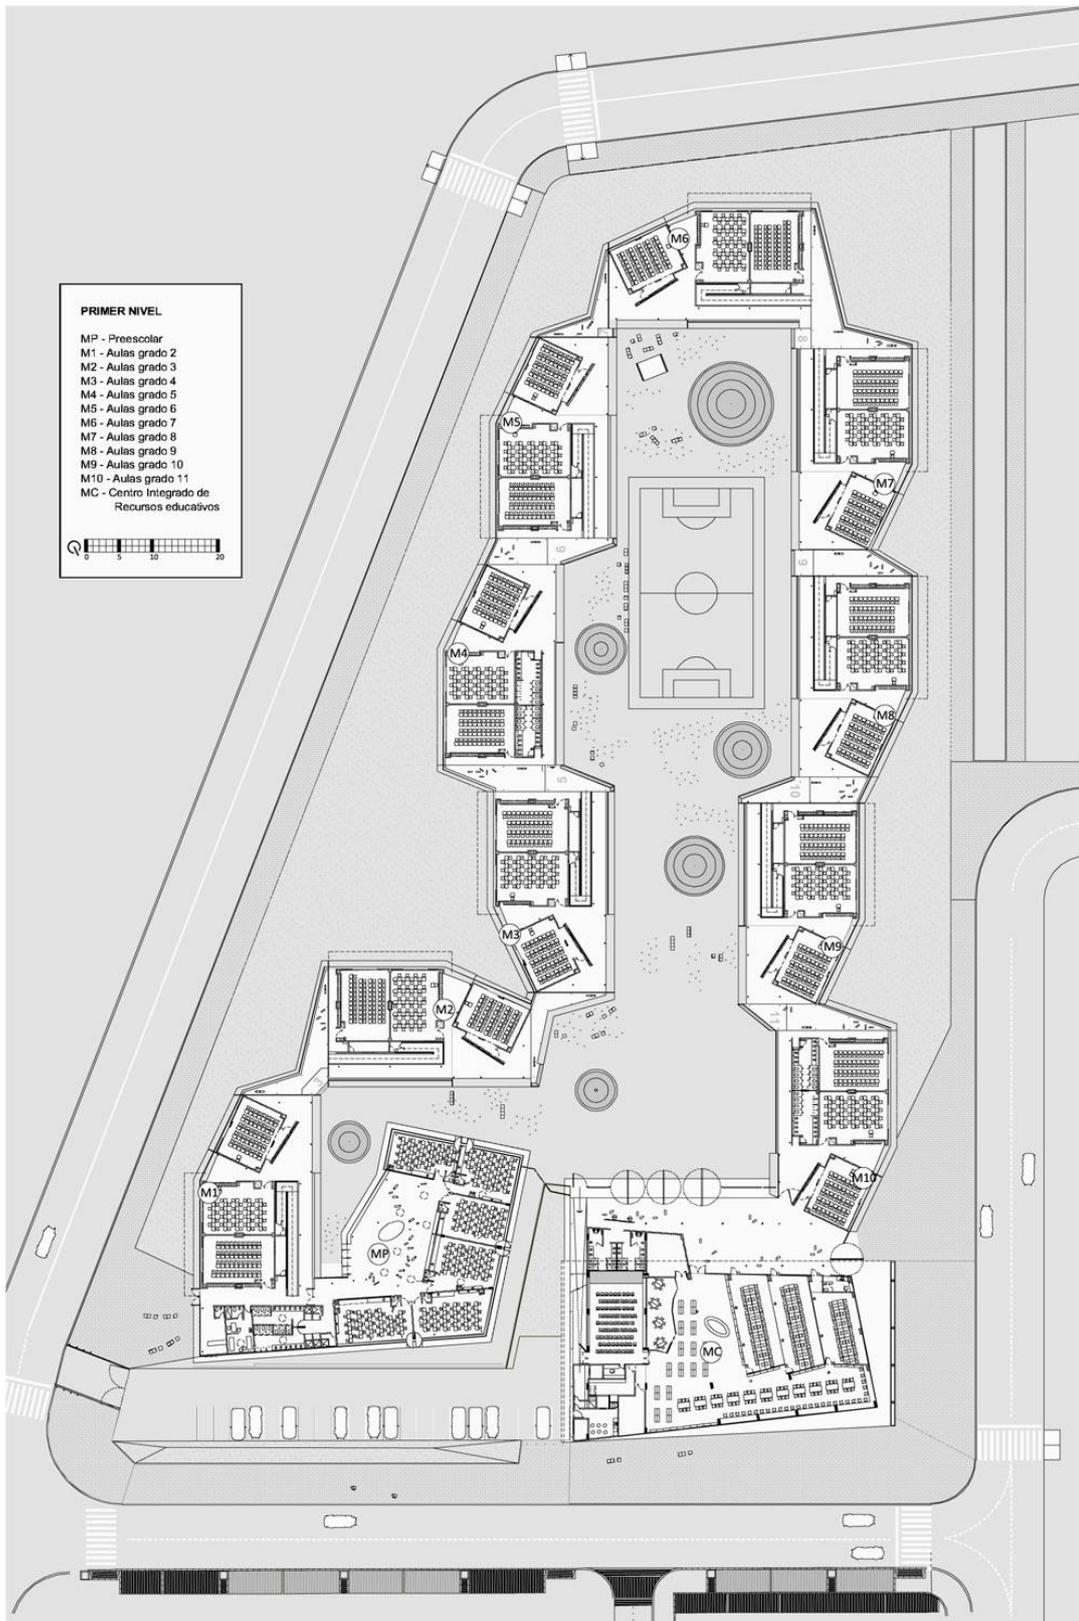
PLANTA PRIMEIRO NÍVEL
